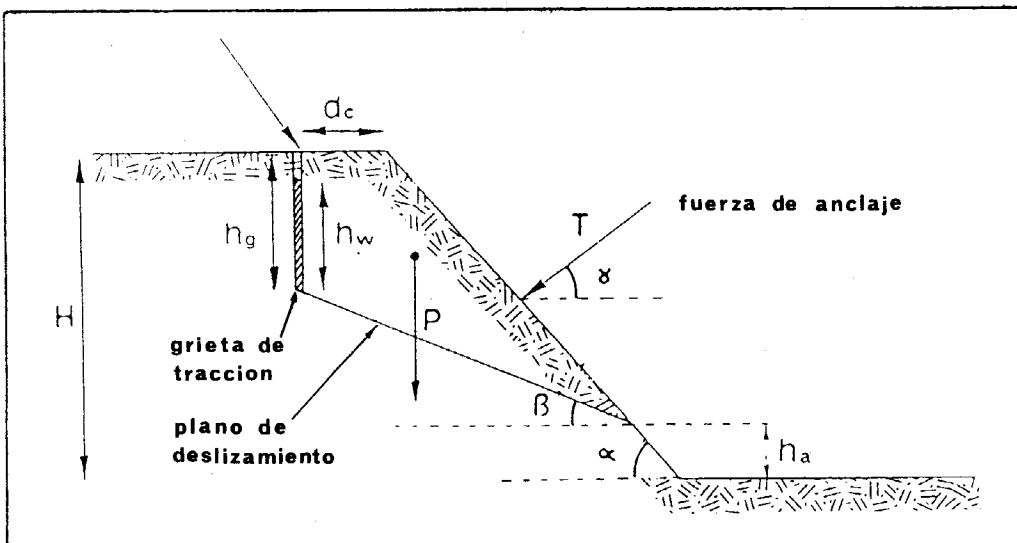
Geometría y esquema de fuerzas de rotura plana de un talud con grieta de tracción.
